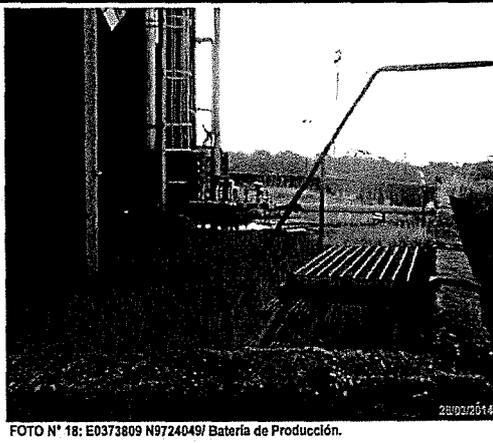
E0373809 N9724049/ Batería de Producción.
